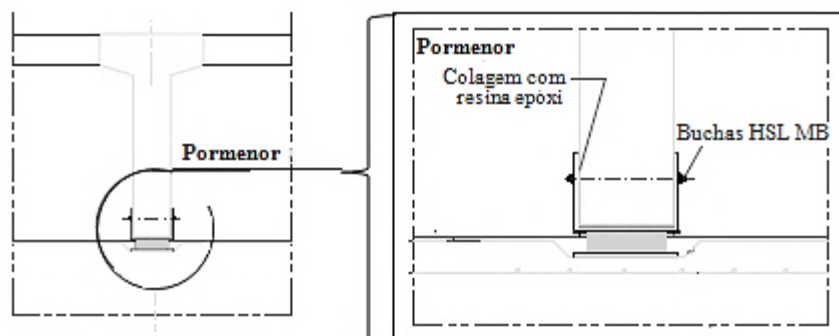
Pormenor da introdução de aparelhos em corte (adaptado de Brisa, 2002b).
